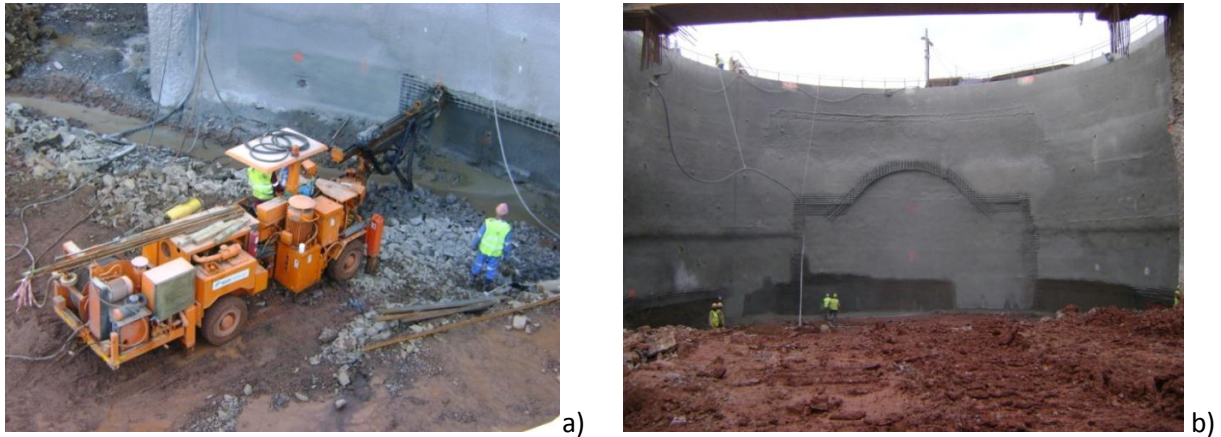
a) Execução de pregagens tipo swellex e execução de geodrenos; b) Emboquilhamento do túnel norte – Poço 1.
